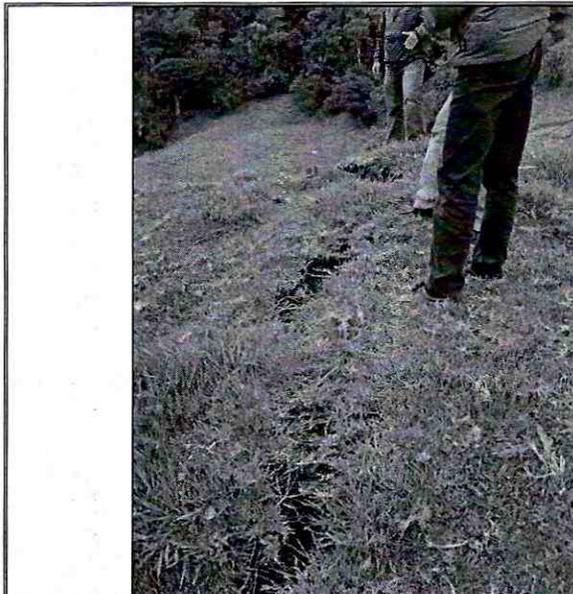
Grieta de tracción identificada sobre la calzada de la vía entre Betania y Nazareth, muestra de la actividad del proceso de remoción en masa.
